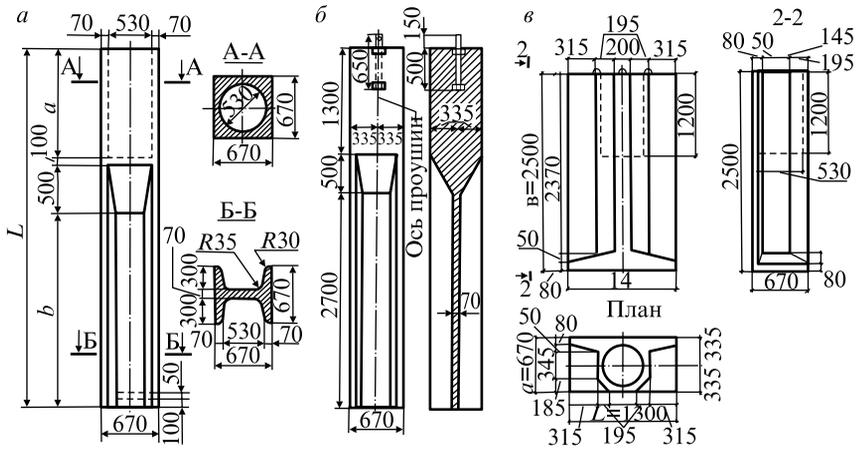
Двутащовый стаканый фундамент ДС (а); анкер ДА (б); блочный фундамент 3Ф-1 (в)
